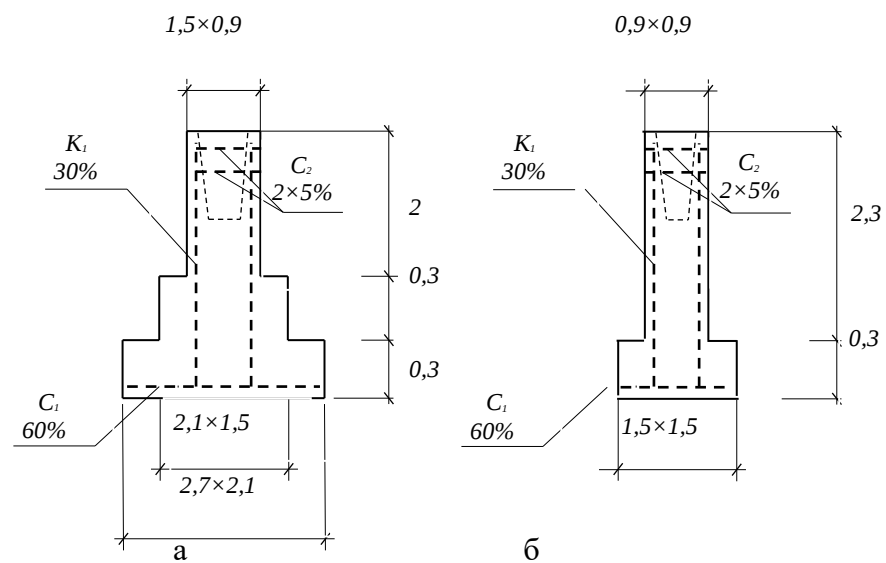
Схема фундаментів марка Ф6.2.3 - а, Ф1.1.1 - б
